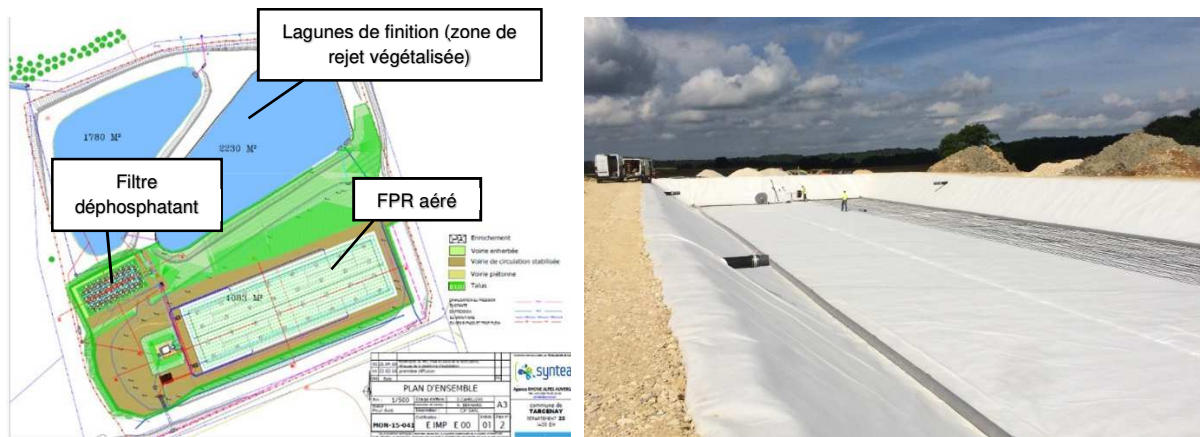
Plan masse de la station de traitement des eaux usées de Tarcenay (25) (gauche), construction du Rhizosph'air® (droite)
